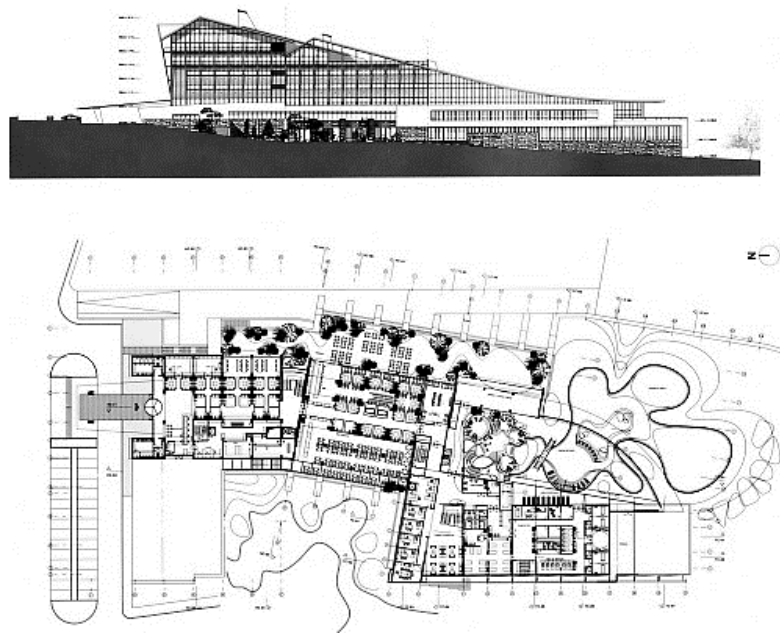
Alçado e Planta do projeto das Termas de Unhais da Serra (Palma, 2004, *in* Pinto e Mangorrinha, 2009).
